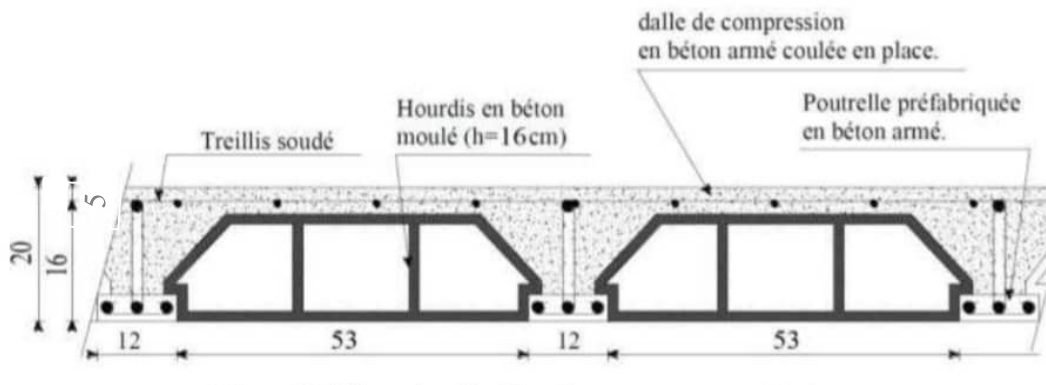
1 Illustration d'un Plancher en corps creux 16+5 [1]
